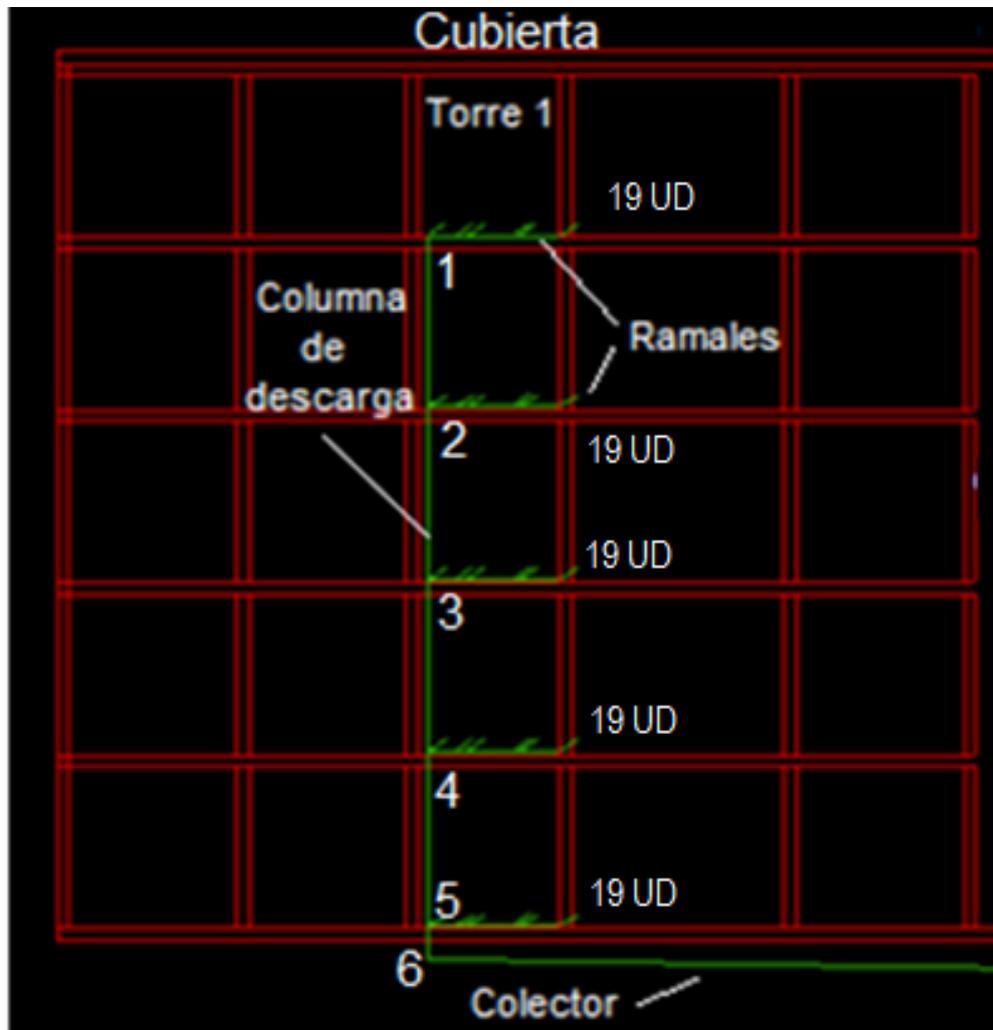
Esquema de la columna de descarga por tramos (torre 1)
